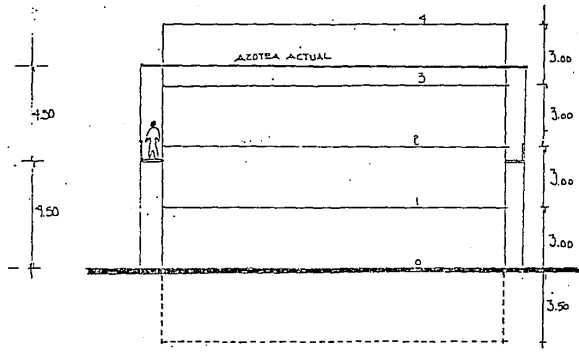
CROQUIS DEL ALZADO DE LA AMPLIACION PROPUESTA
